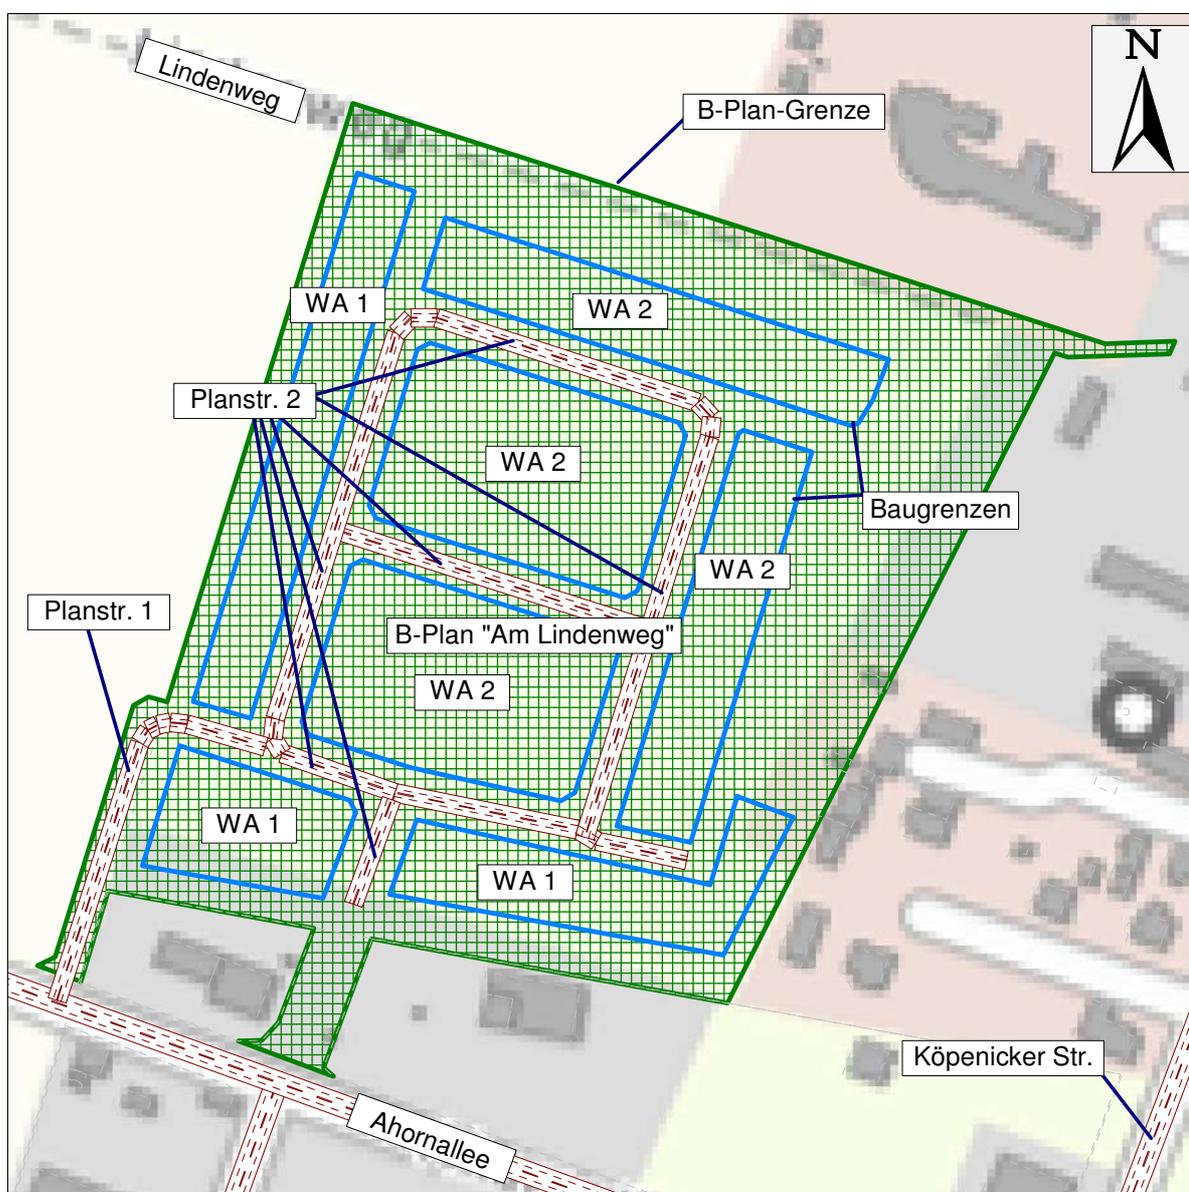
Lageplan des B-Plan-Gebiets in der Umgebung
